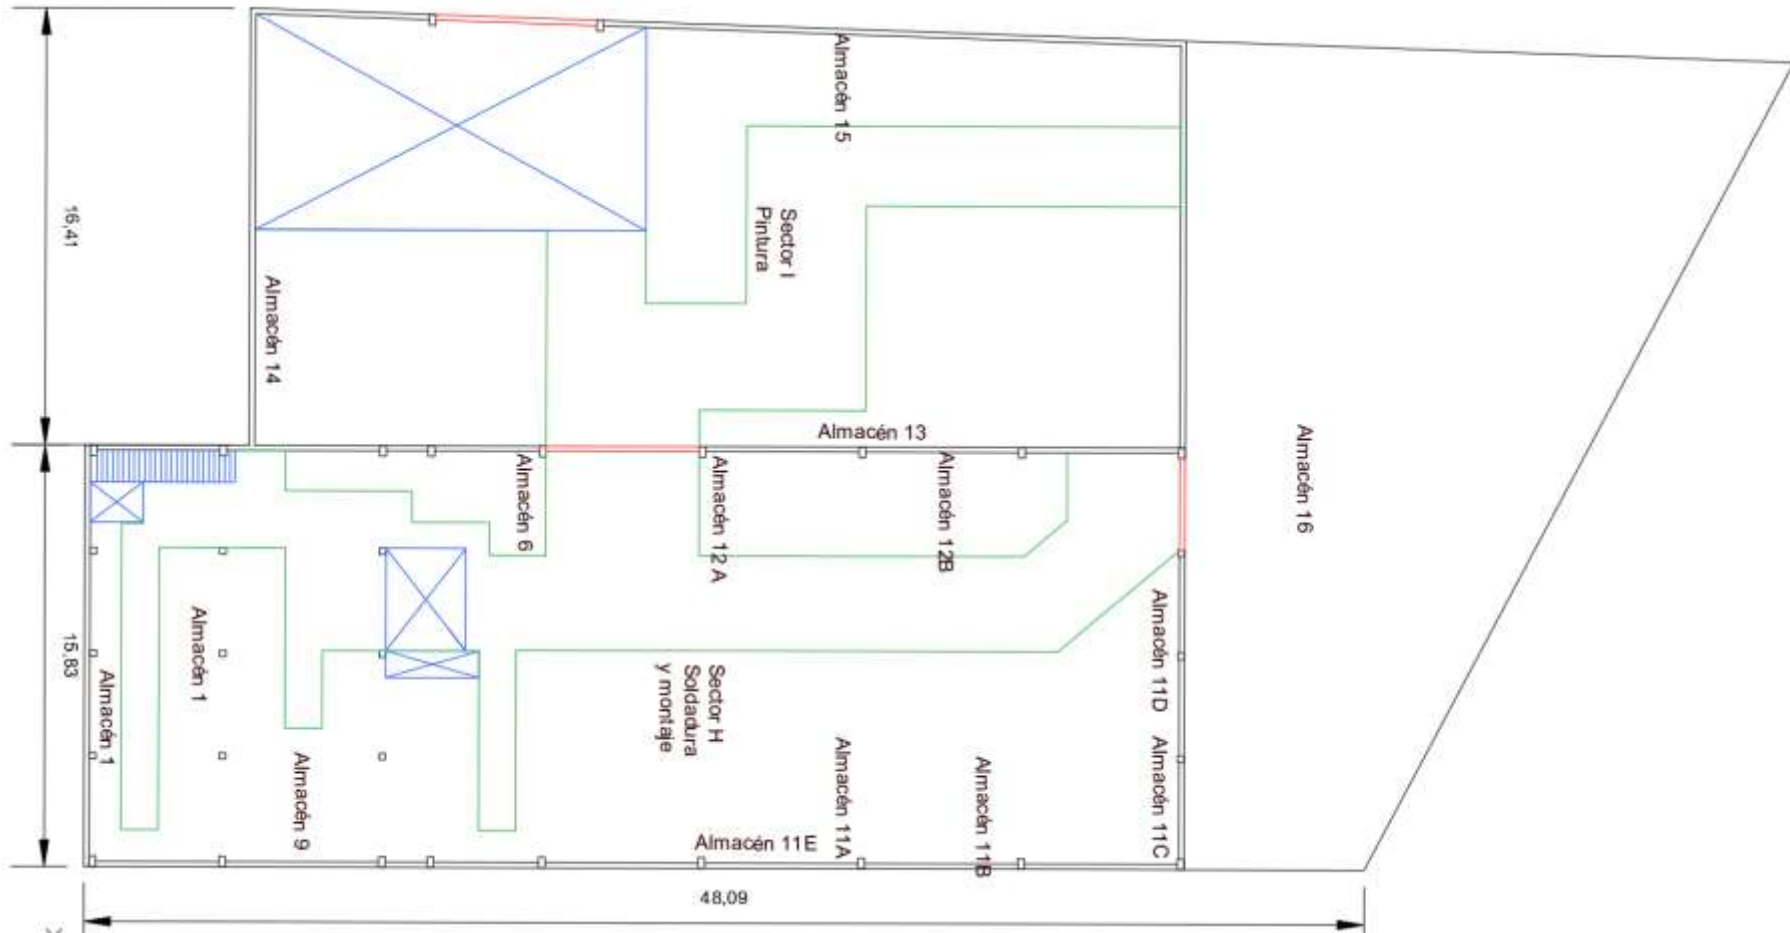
Lay-out planta inferior. Fuente: Elaboración propia
